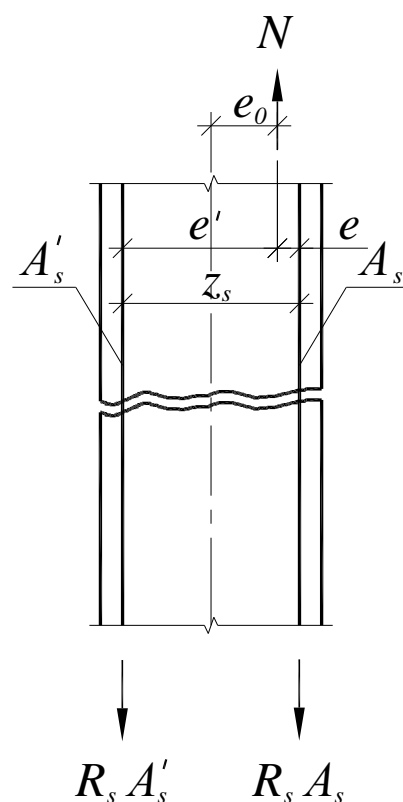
Расчетная схема растянутого элемента при малых эксцентриситетах.
